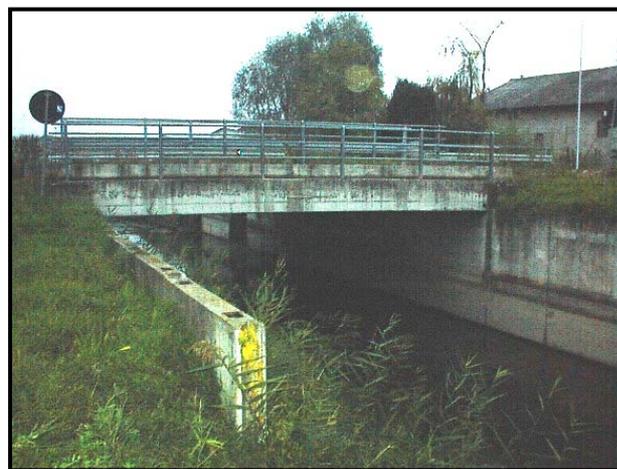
Vista da monte del ponte stradale, all'ingresso dell'area industriale.
